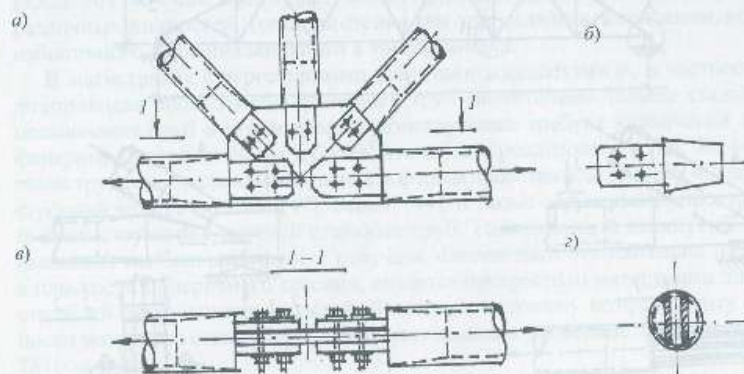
Узел В нижнего пояса: а – фасад узла; б – пробка с выпуском; в – план узла; г – выпуски в торце трубы
